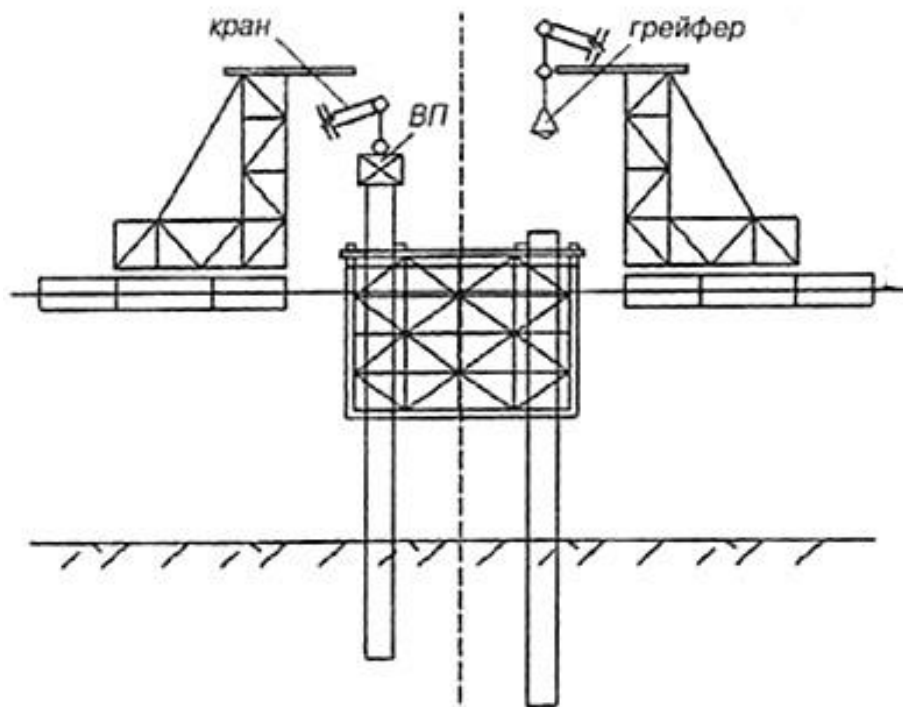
Занурення палі-оболонки з нарощуванням секцій і розробкою ґрунту із внутрішніх порожнин оболонки
